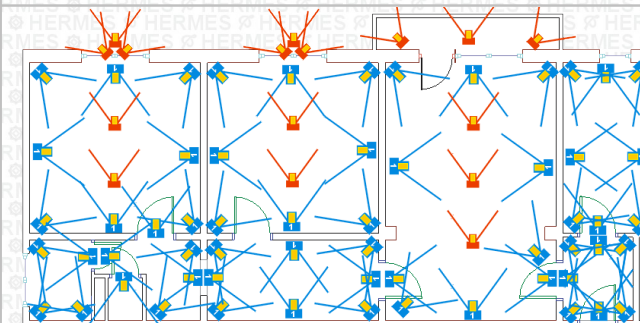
DETAILS VYBAVENIA PRIESTORU
